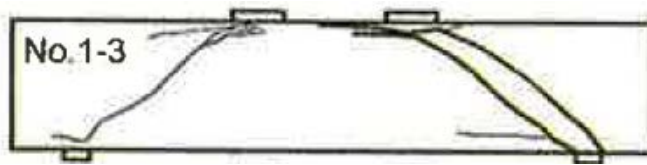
試験体のひび割れ状況⁵⁾
